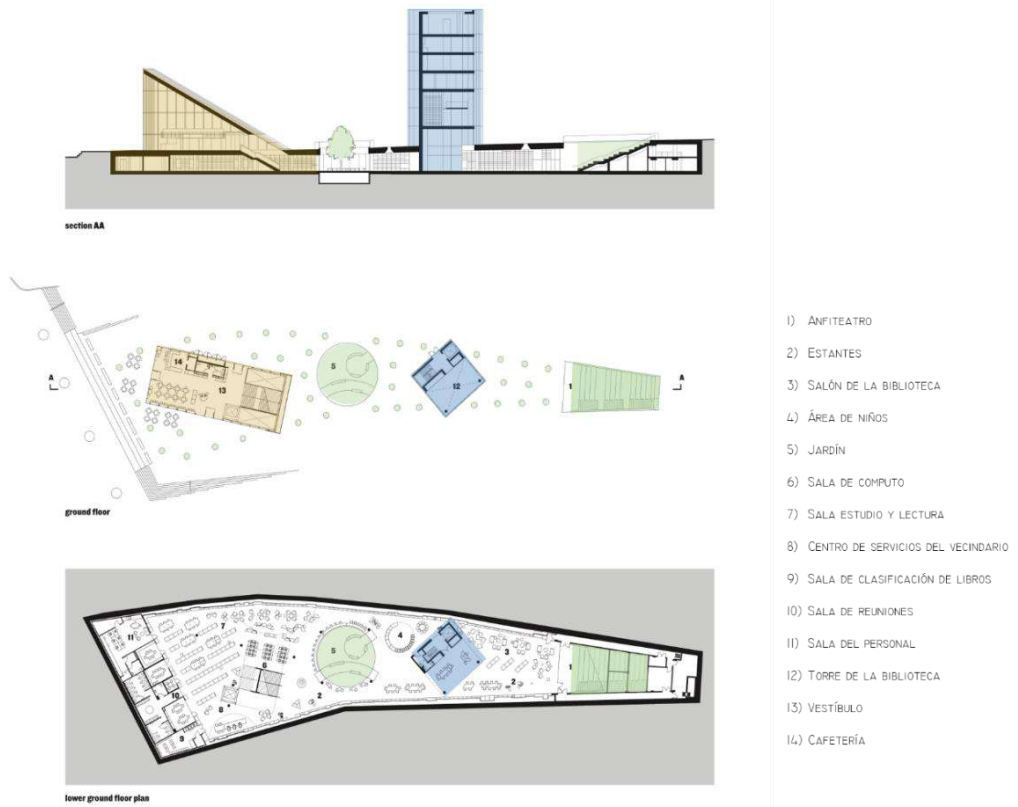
Plantas y secciones de la Biblioteca, edición propia
